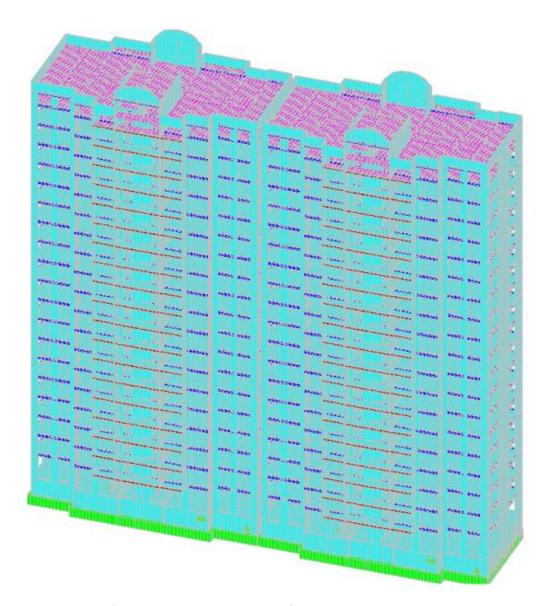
Расчетная модель здания на фундаментной плите в ПК SCAD
